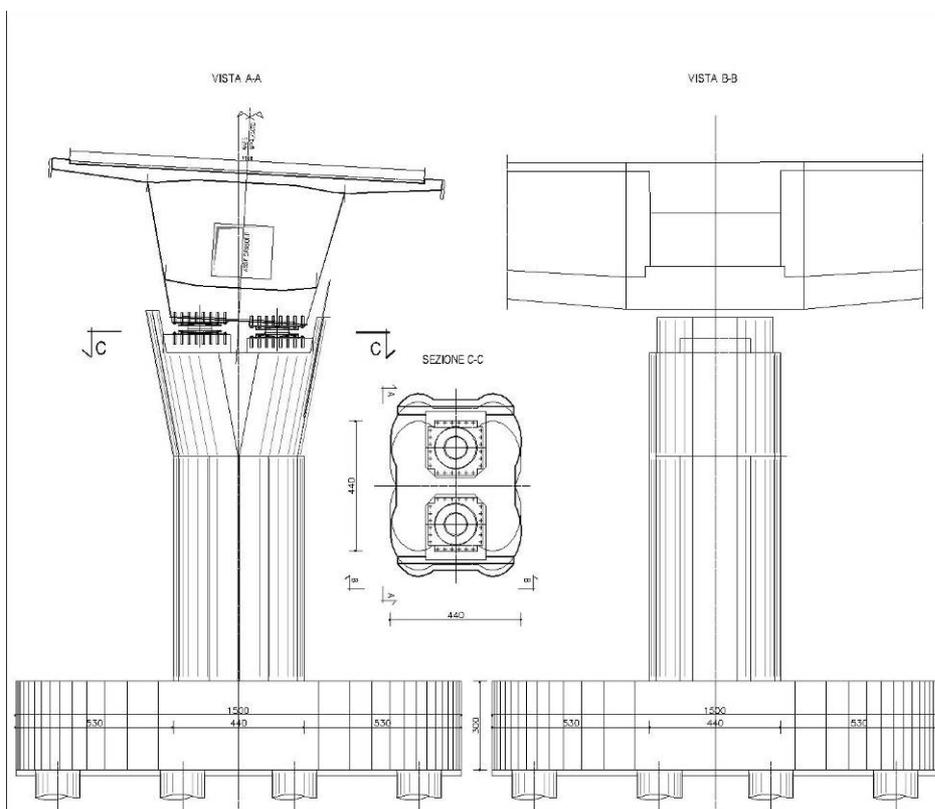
Sezioni trasversali e longitudinali degli impalcati su pila e pianta del pulvino - Progetto Esecutivo.
